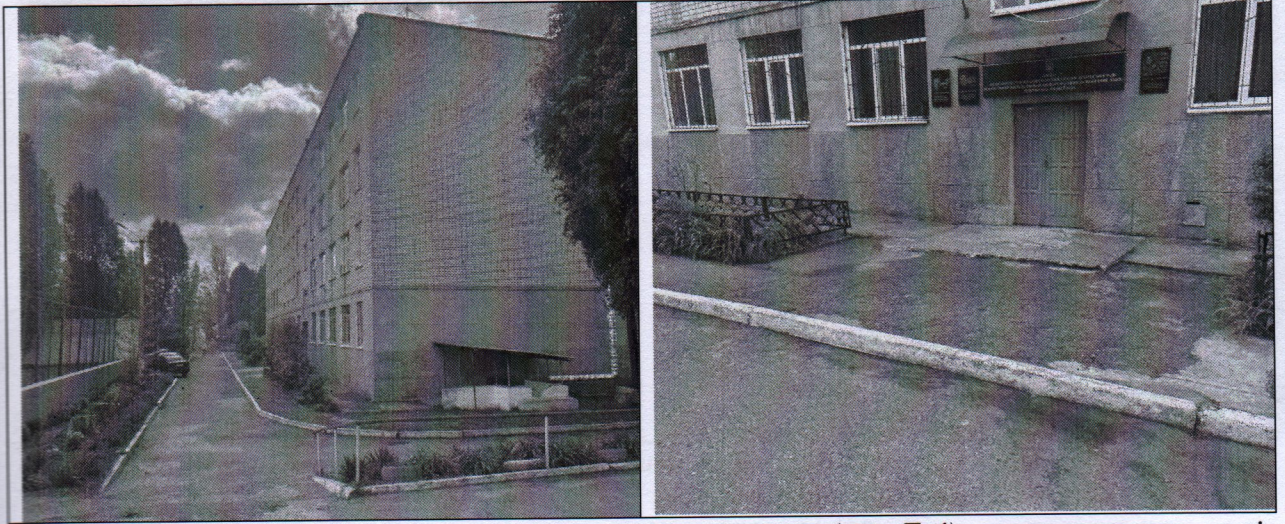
4-поверхова будівля навчального корпусу ліцею (літ. Б-4) – прямокутна в плані цегляна споруда з підвалом, яка розташована на окремій огороженій земельній ділянці. На внутрішньому фасаді будівлі улаштовані 2 (два) відкриті танки входів з площадками та металевими навісами. Бетонна площадка перед входними дверима розташована на рівні +80мм від рівня з конструкції вимощення з асфальту. Поточний технічний стан будівлі у цілому – задовільний (2-га категорія технічних станів).
